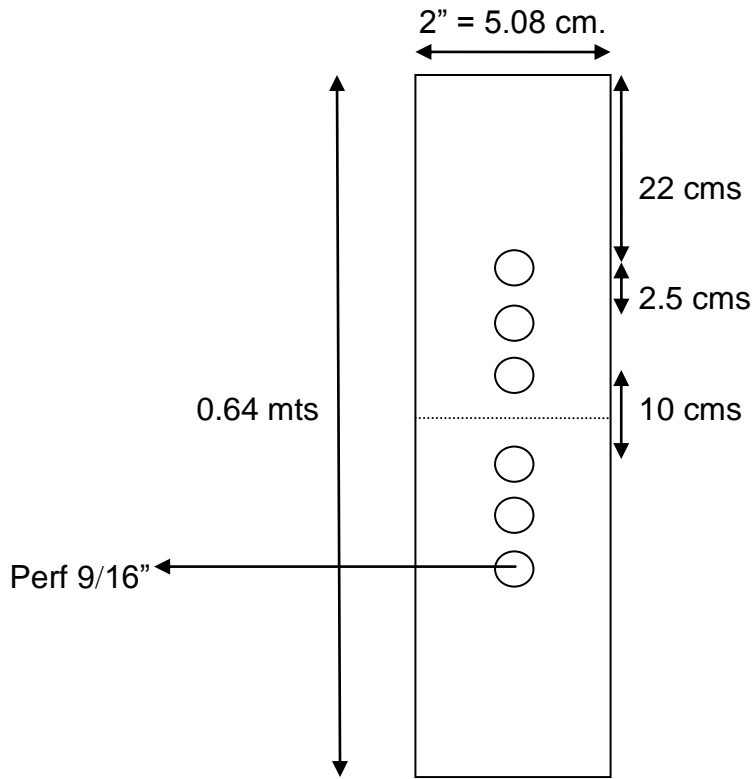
Geometría de la Platina Pernada - Soldada.
